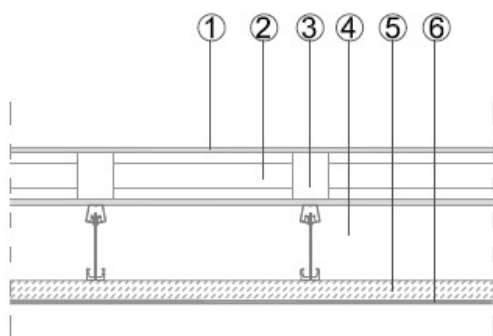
Pormenor construtivo do pavimento da fração destinada à habitação.
